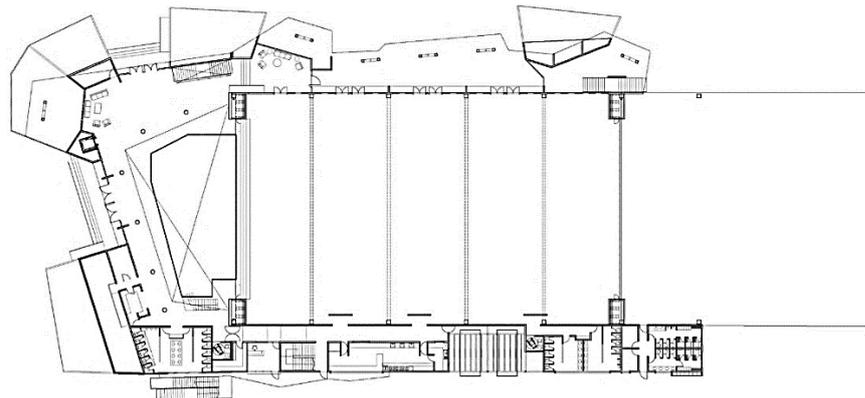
, Centro de Eventos Puente Verde – Plano Primer Nivel
